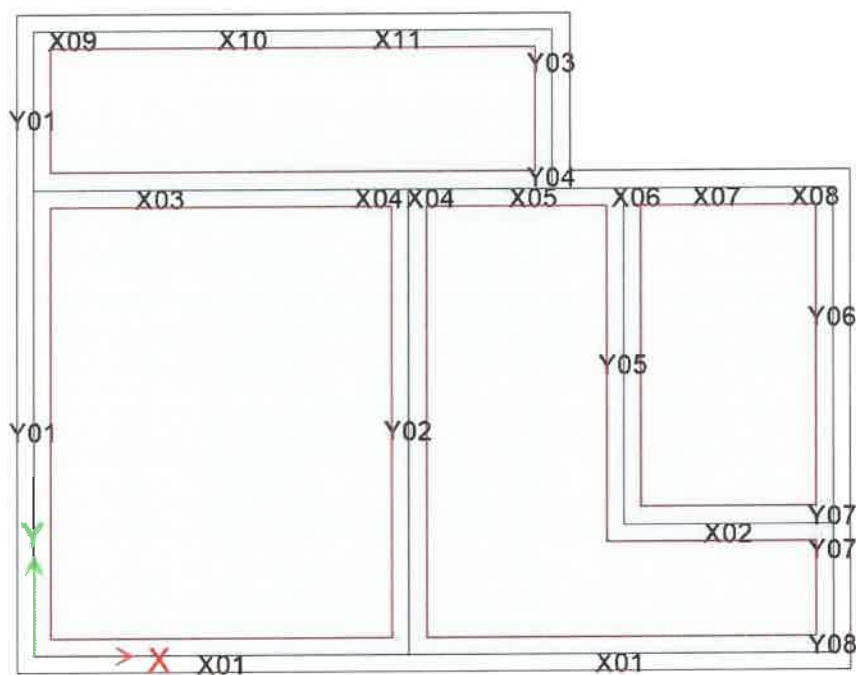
Vedere in plan spaleti din zidarie (parter)
